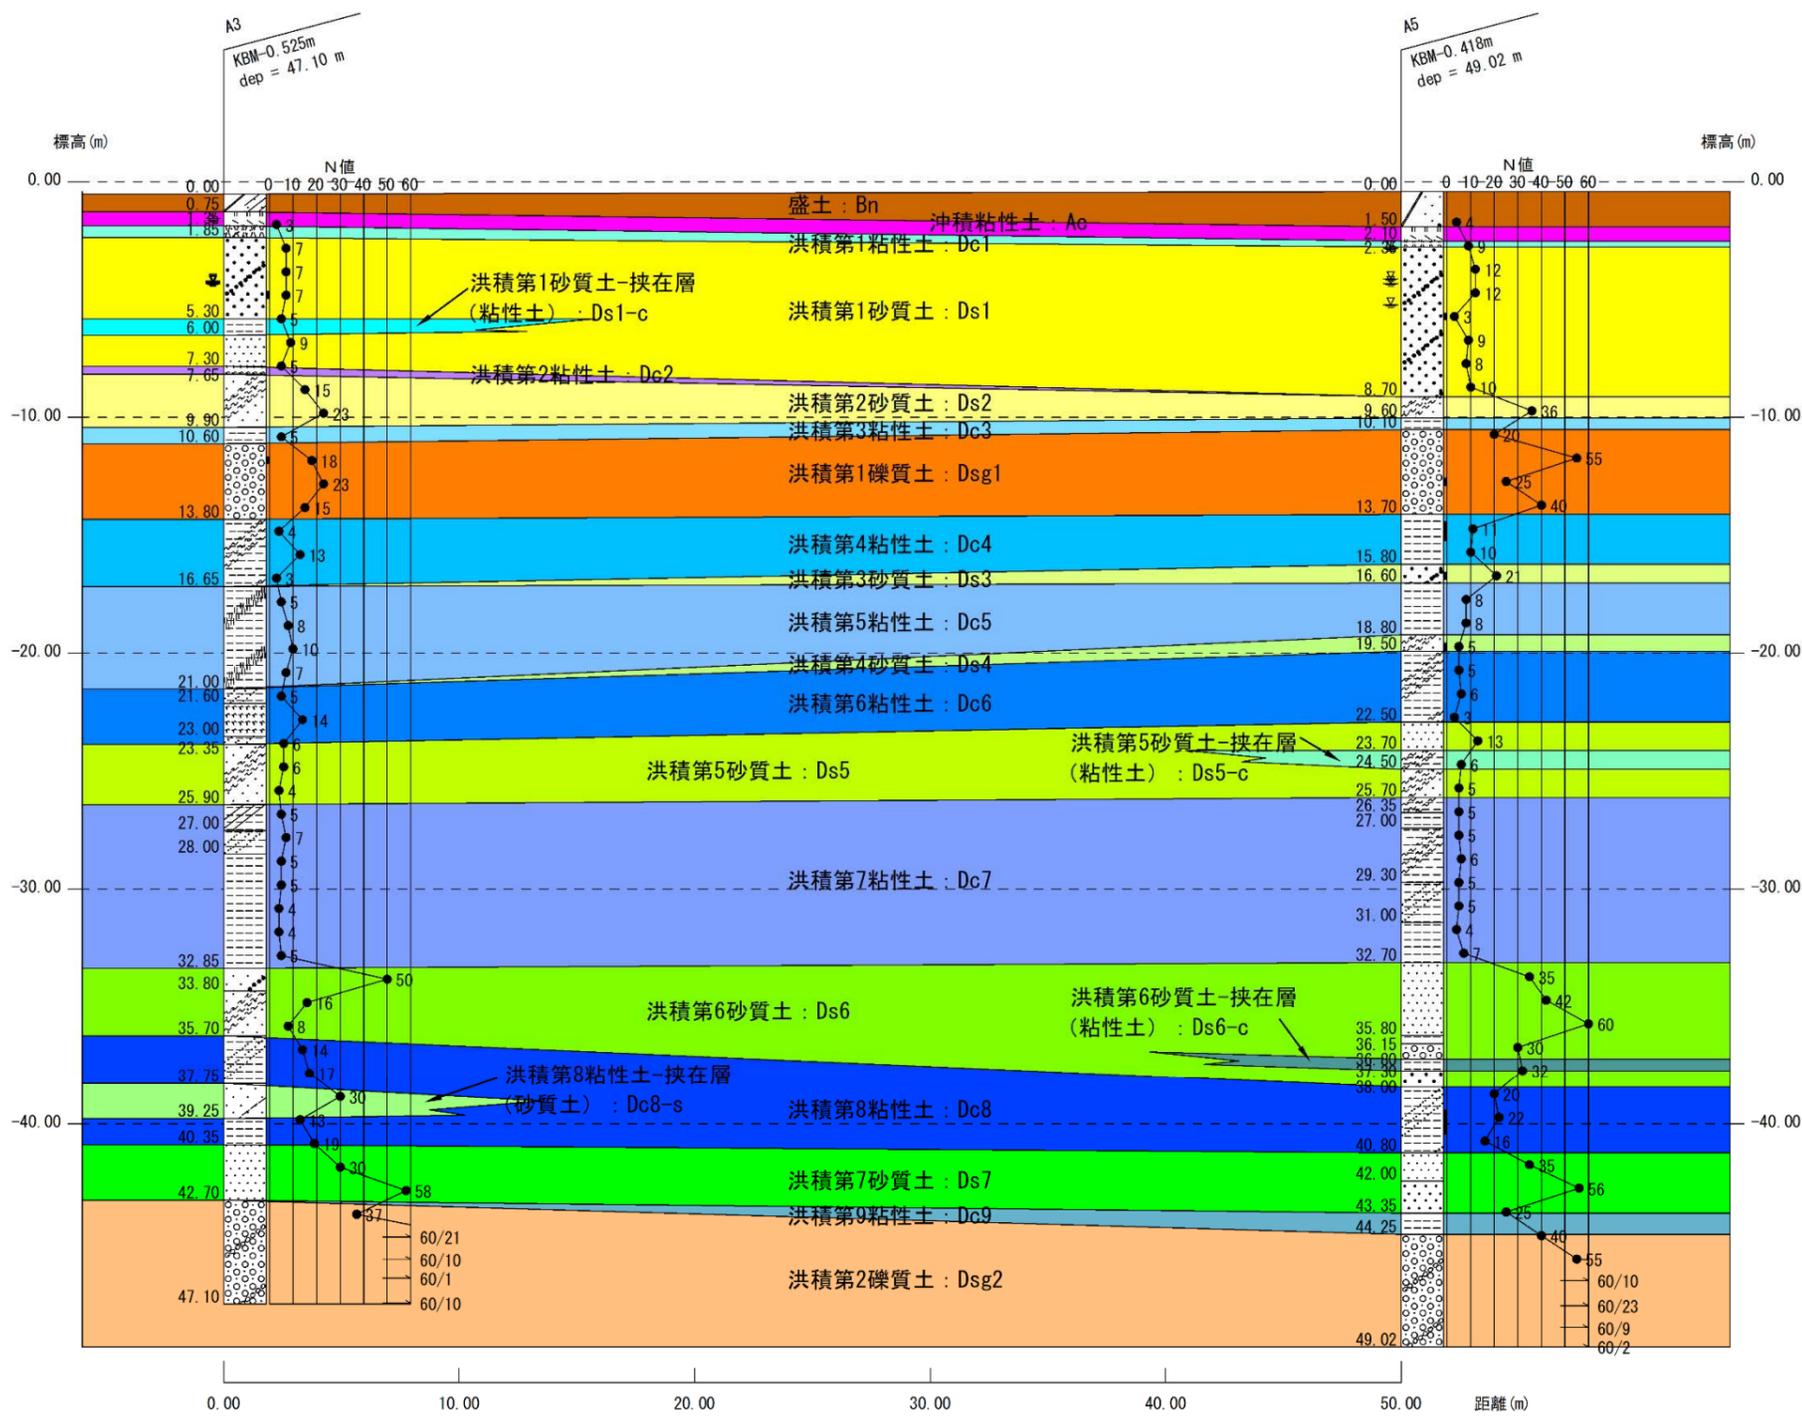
推定地層断面図 A3-A5 (S=1/300)
